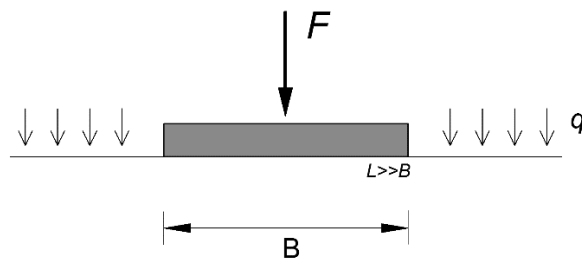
Fundação de comprimento infinito sujeita a um carregamento vertical centrado.
